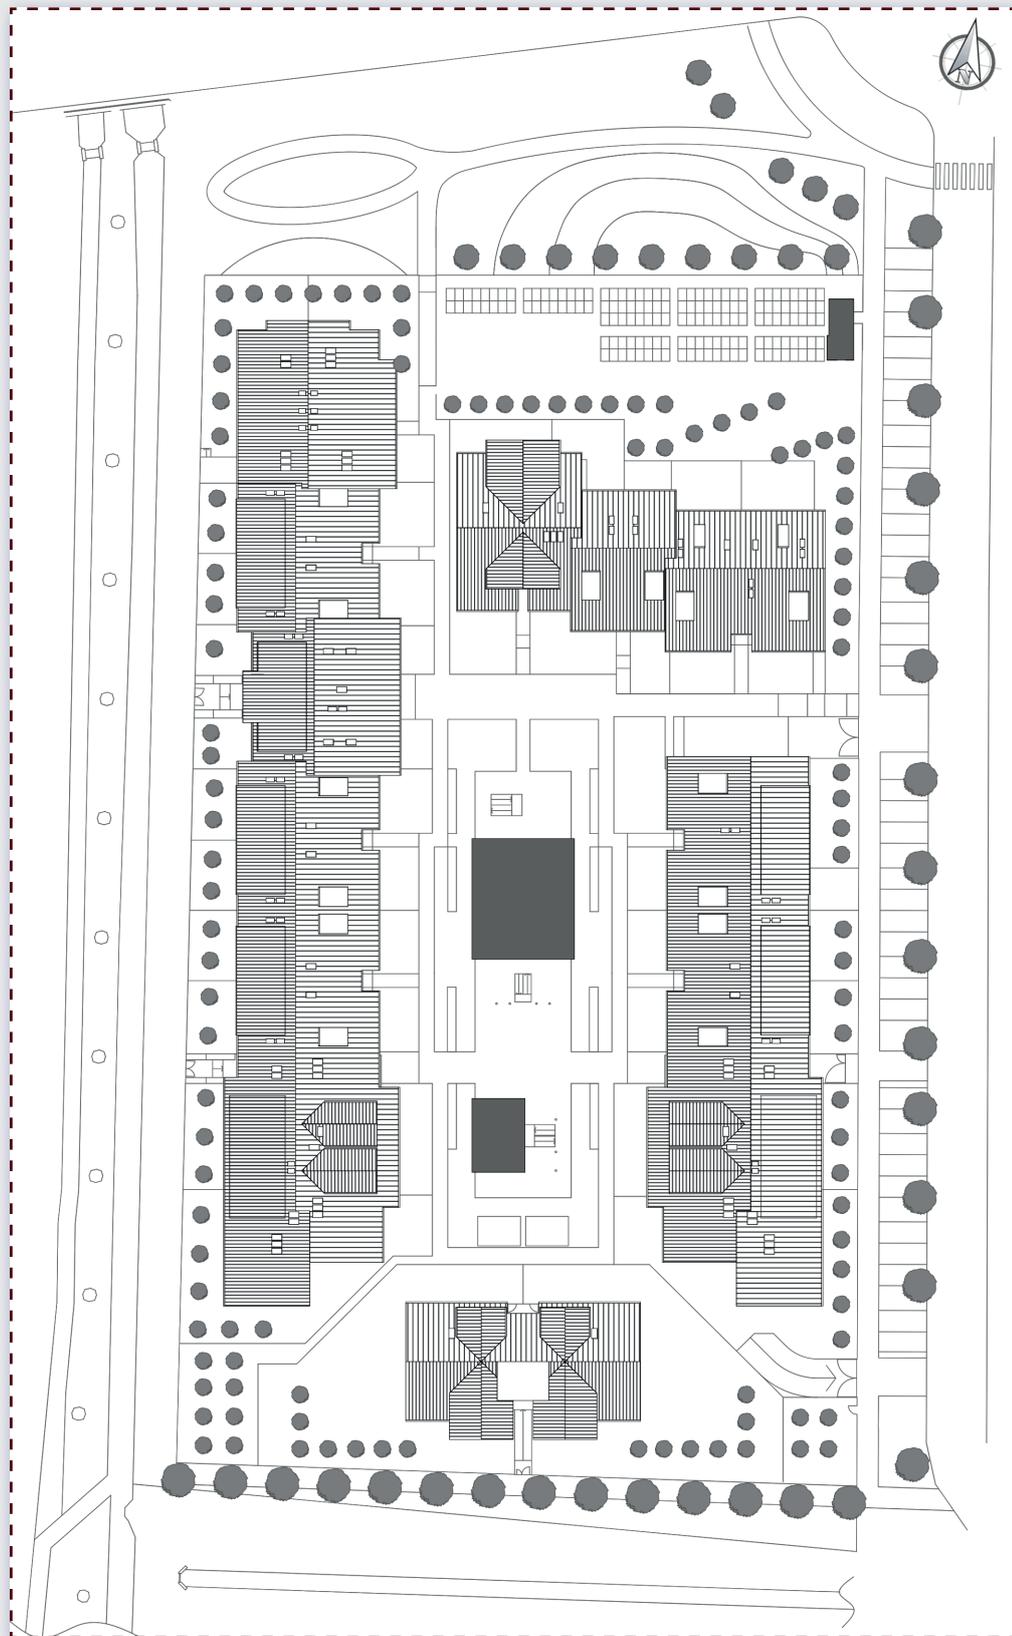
Planimetria generale del complesso residenziale - piano primo
